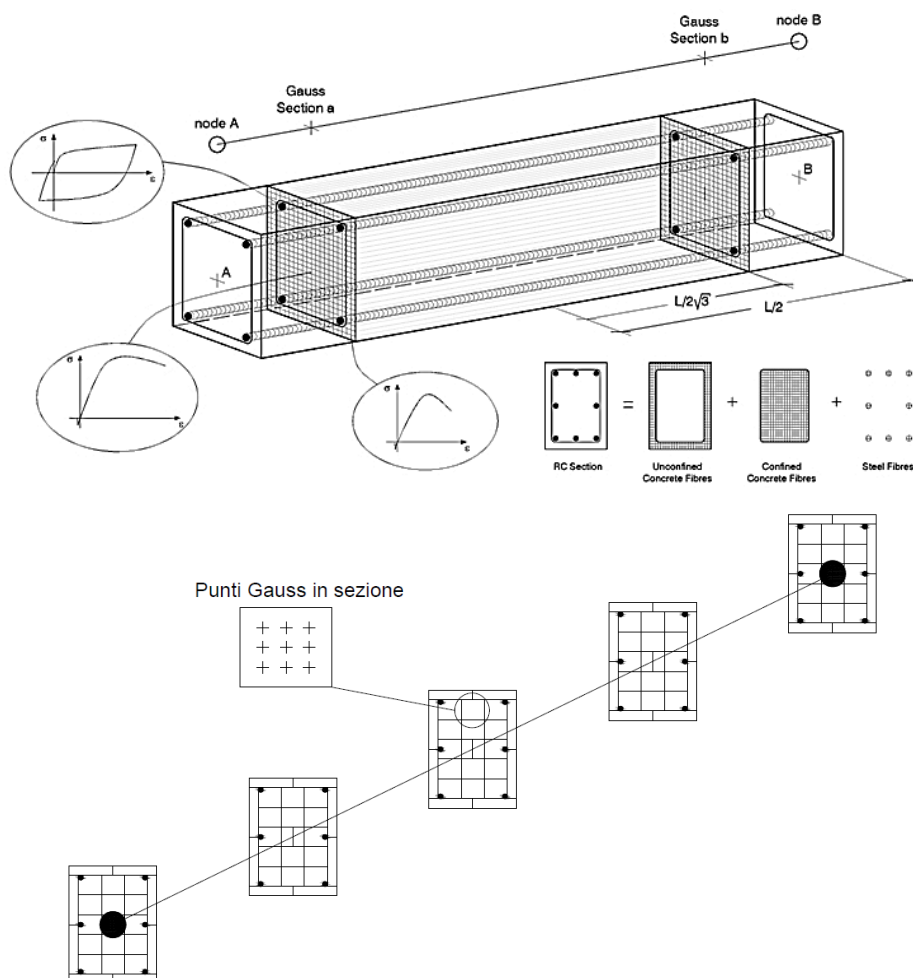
Schema di modellazione a fibre degli elementi strutturali a comportamento elasto-plastico non-lineare
